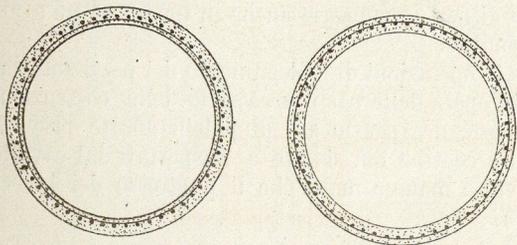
Tubi in *béton* armato, soggetti a pressione prevalente rispettivamente esterna ed interna.
